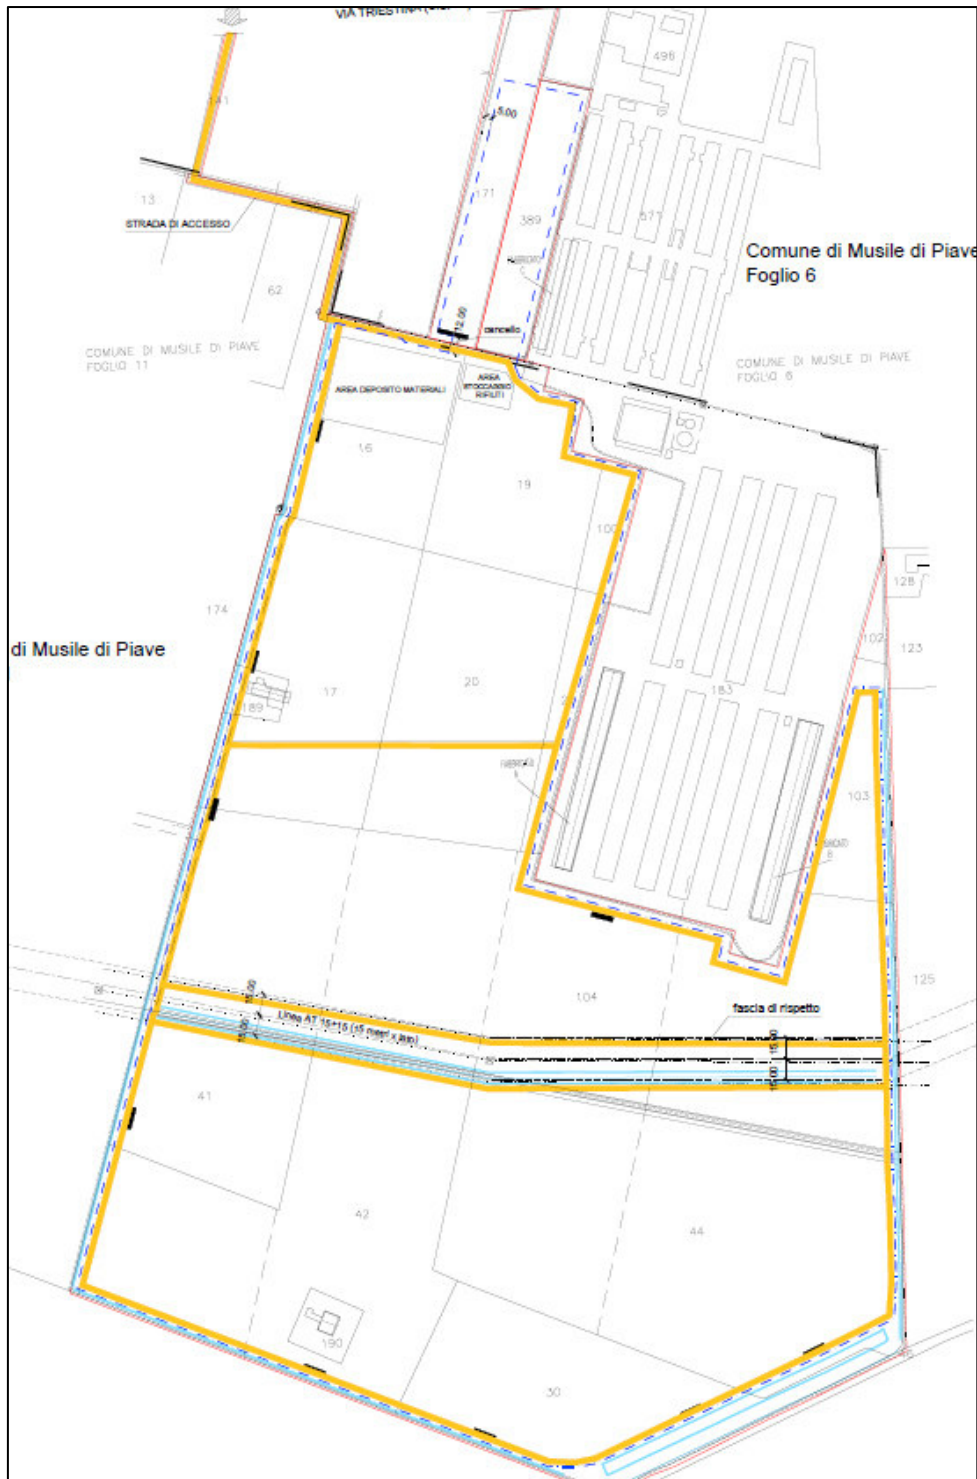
Planimetria di cantiere; in arancione la viabilità di cantiere, mantenuta anche in fase di esercizio dell'impianto a fini manutentivi
